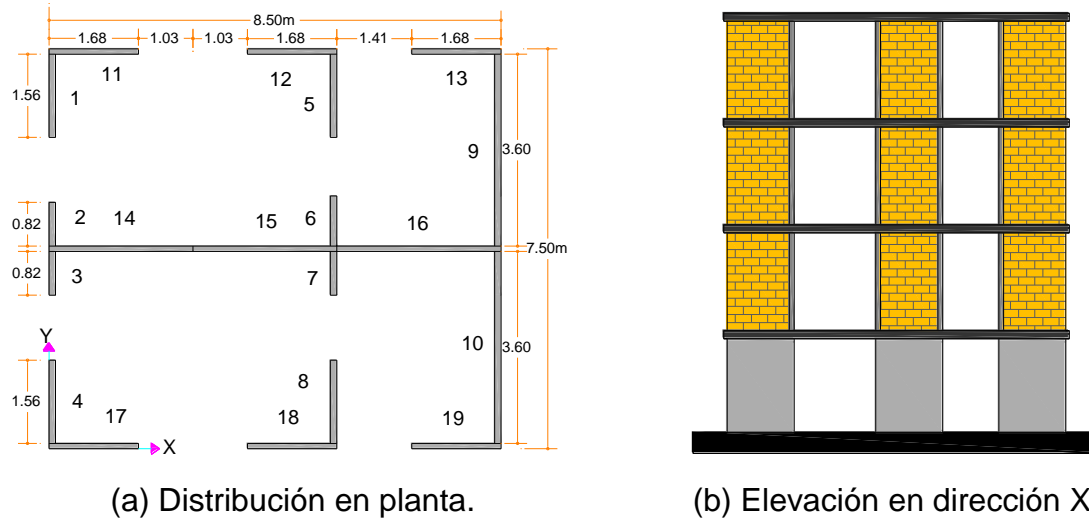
Planta y elevación de estructura de concreto reforzado y mampostería confinada.
